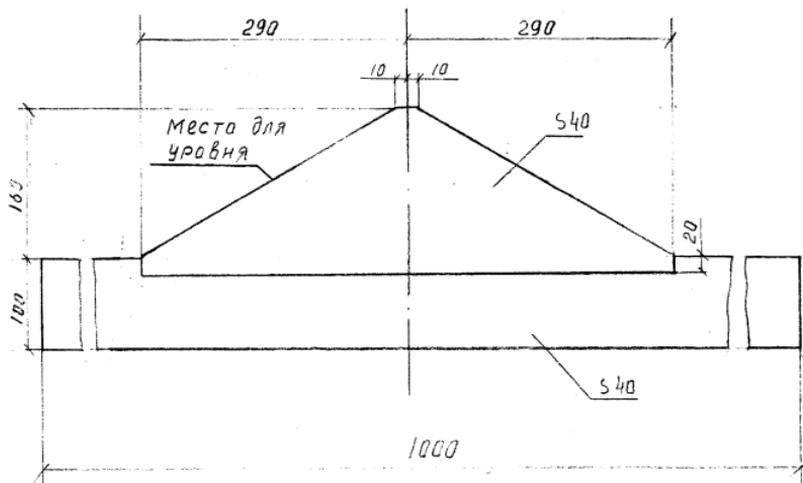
Шаблон деревянный для проверки уклона дна котлована под анкерную плиту для опоры ПУСБ 110-1
